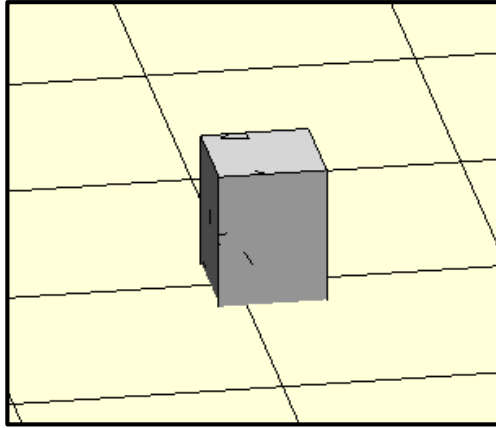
Vista en 3D del Bloque D – columneta mal ubicada
